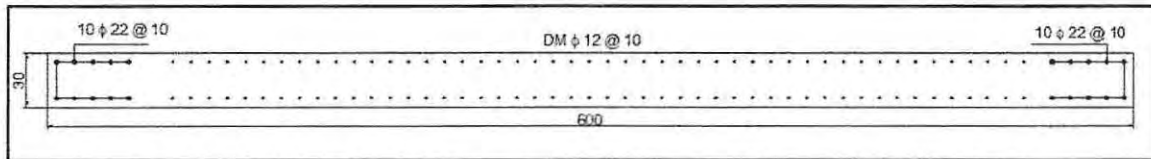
Armadura de flexo-compresión Muro 1, Estructura VII (Aislada).
